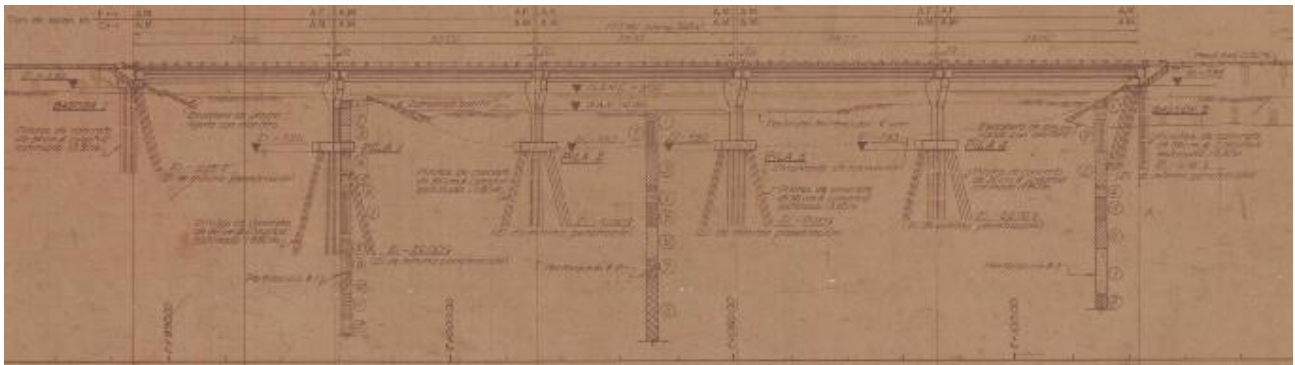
Elevación del Puente (Fuente: Planos originales del Puente Barranca Ruta 23)
